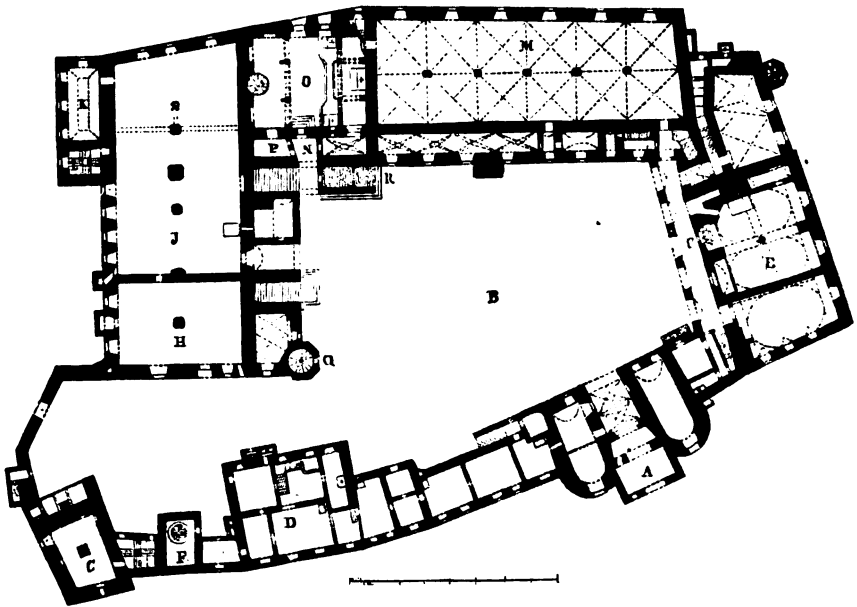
Trausnitz. Grundriss des Erdgeschosses.
